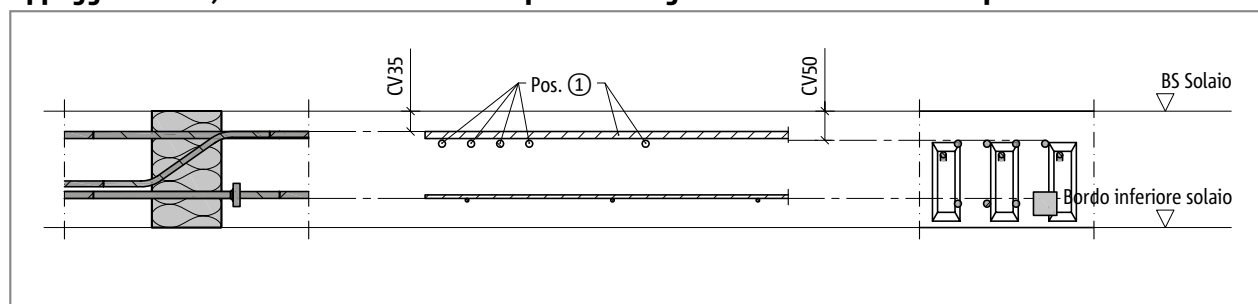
Schöck Isokorb® tipo EXT: armatura in opera angolo esterno (sezione EXT-L-CV35; vista EXT-R-CV50)
